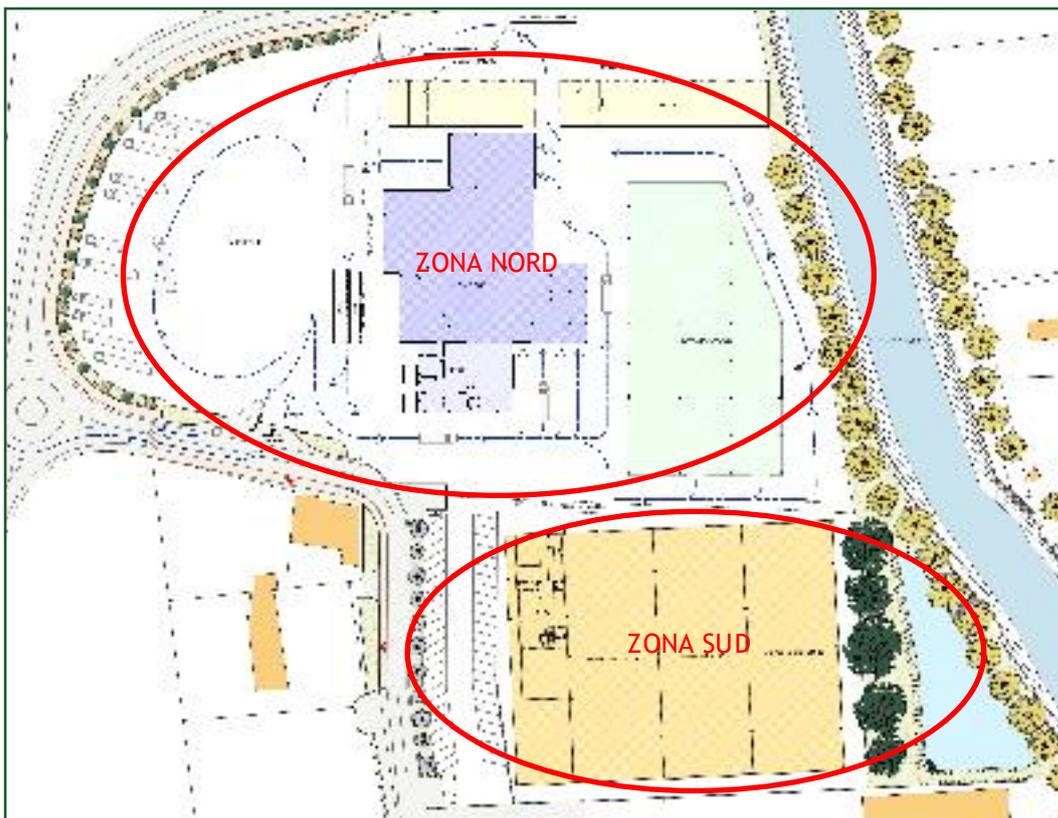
ESTRATTO DI PROGETTO DELL'AREA OGGETTO DI INTERVENTO.
